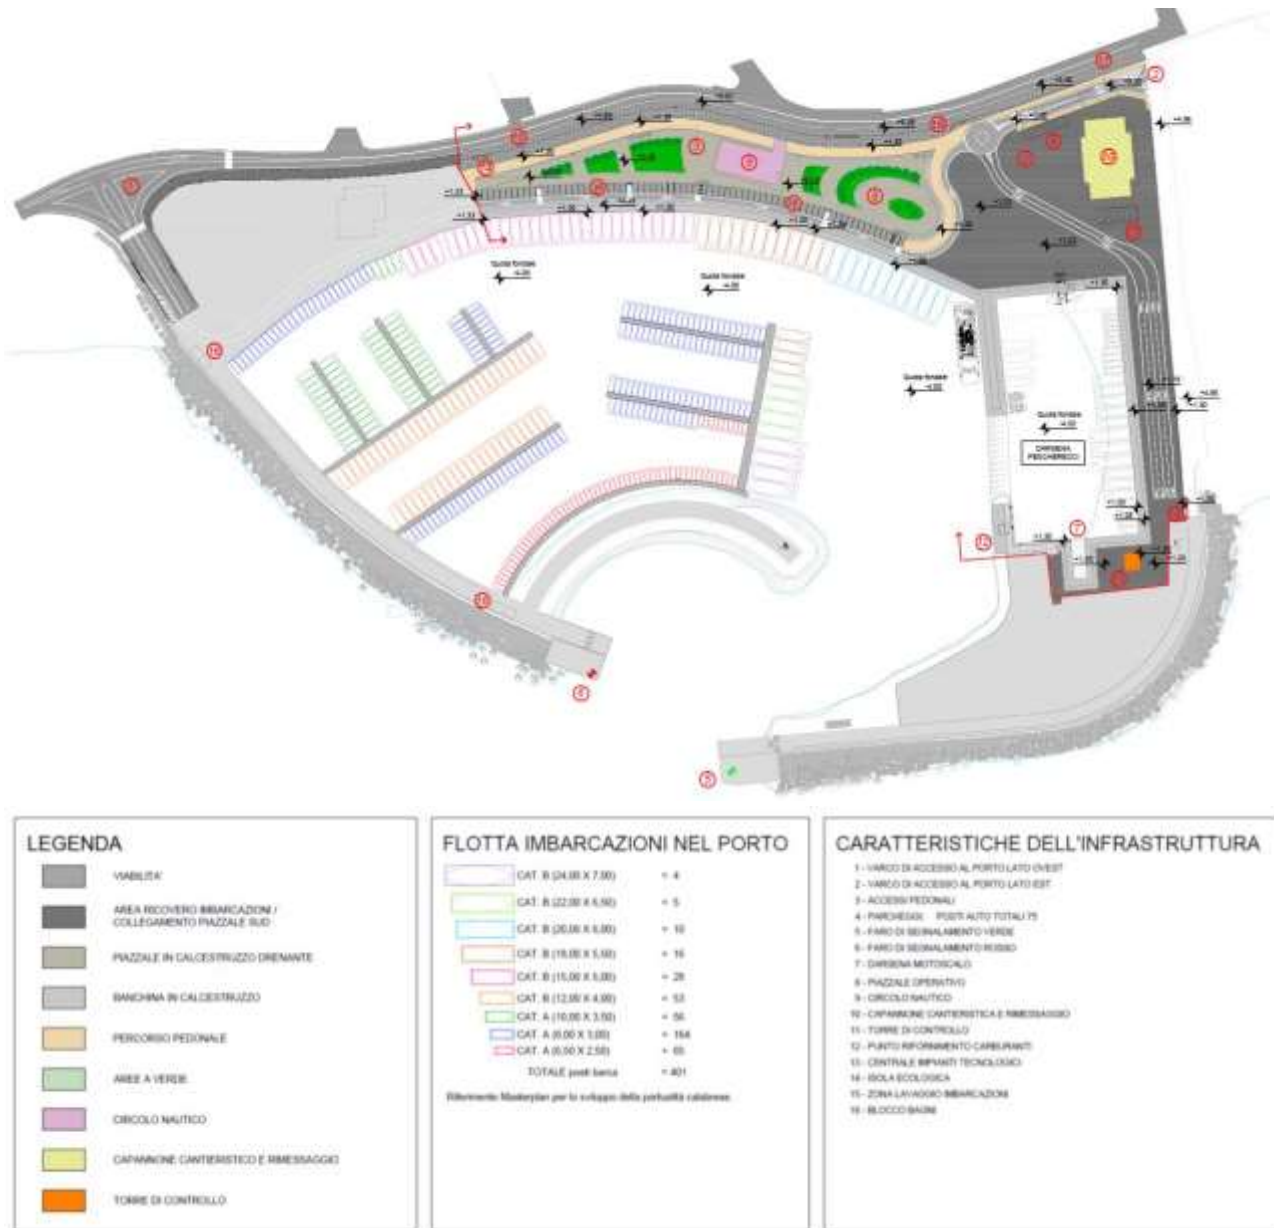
Porto di Catanzaro Lido, planimetria generale di progetto
